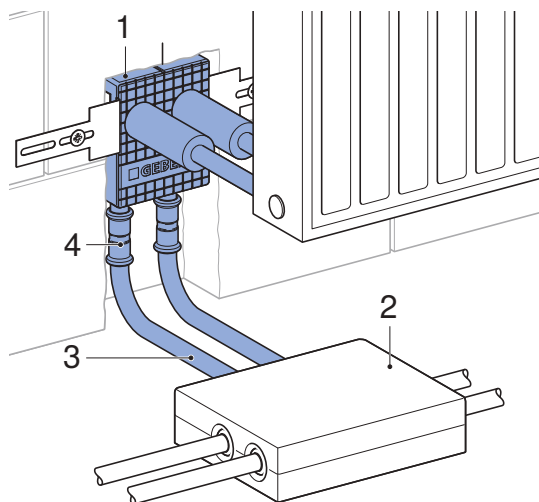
Caja de conexión de radiador tipo L para construcciones de soldado bajas
